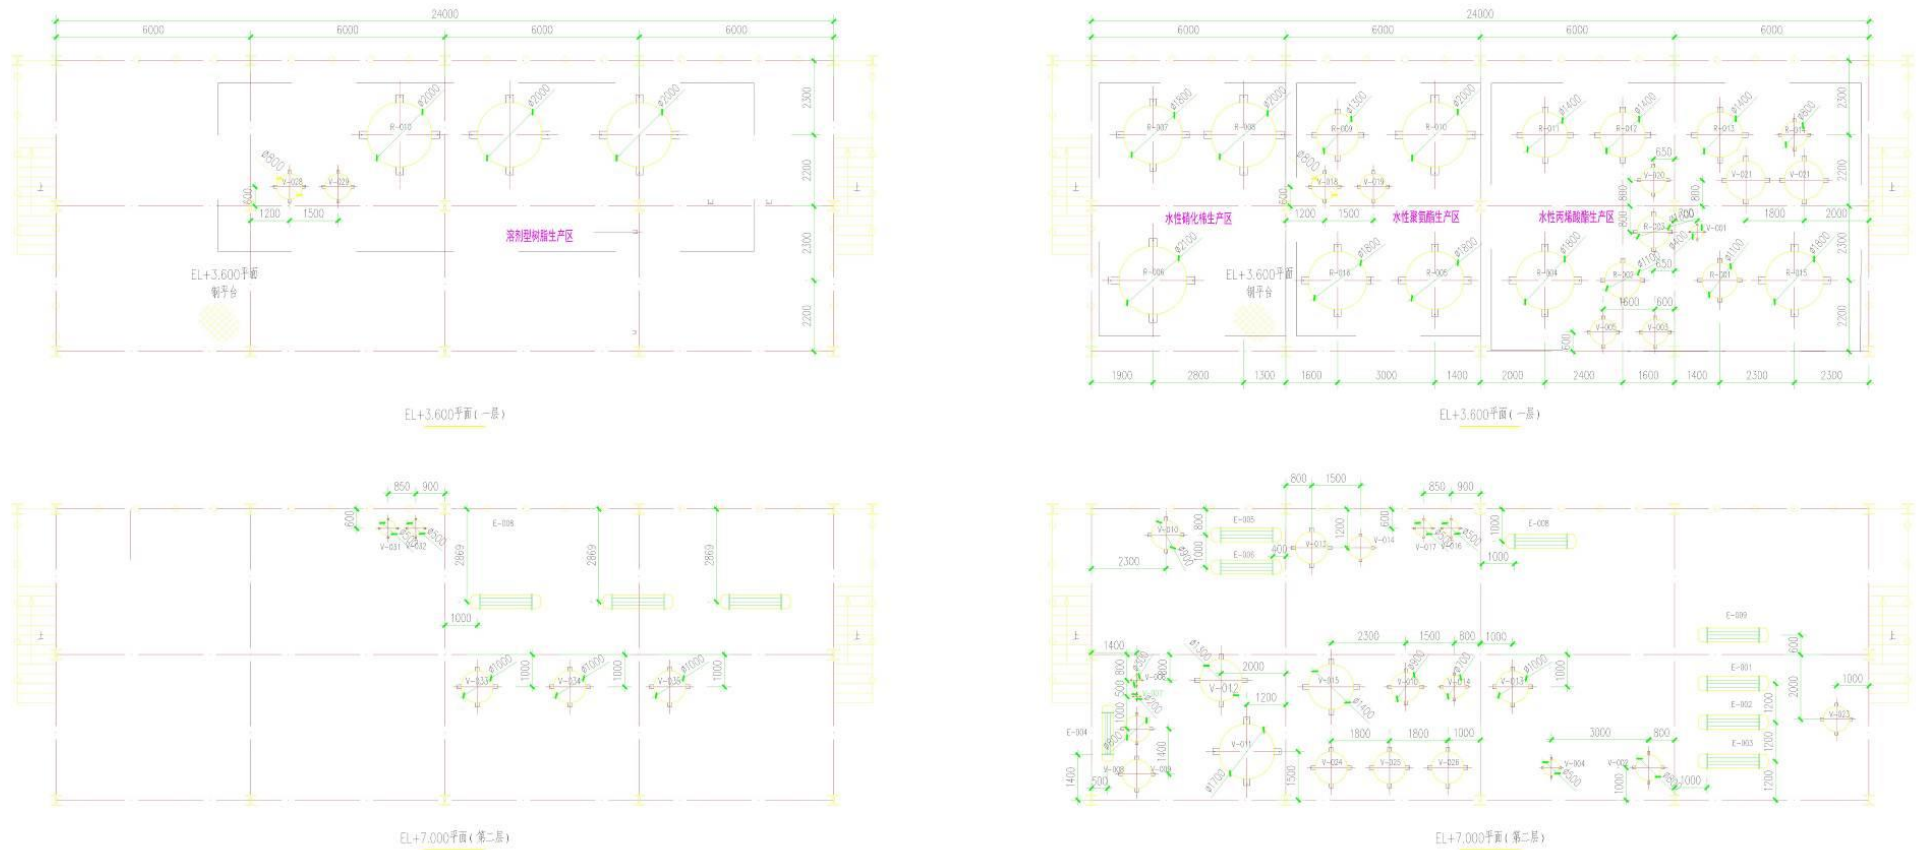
技改后公司主体生产车间设备平面布置示意图
